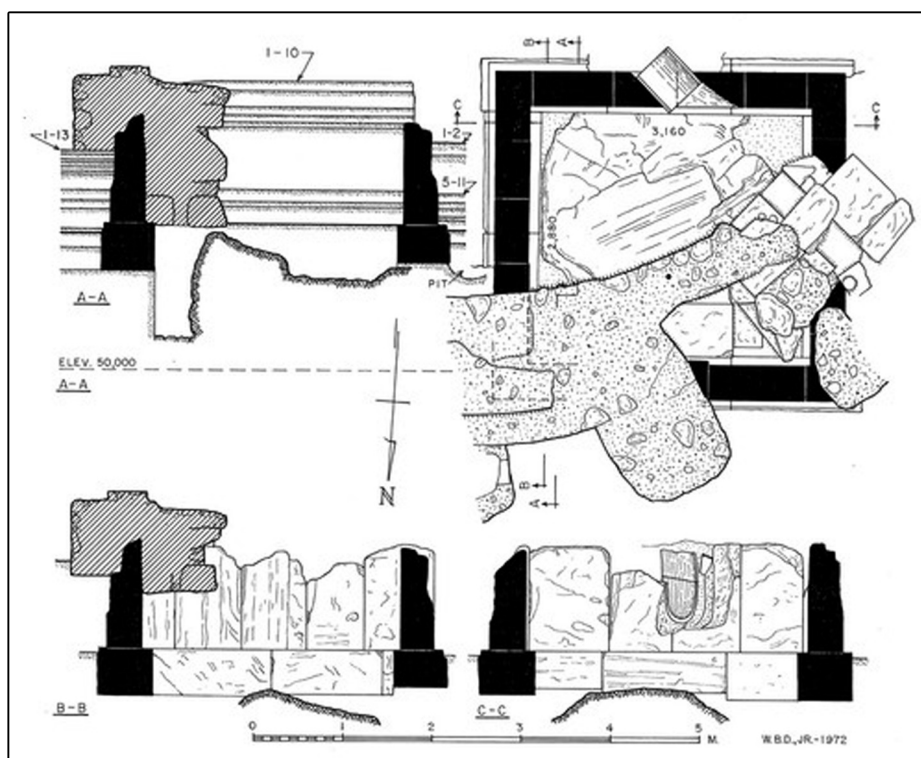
Pianta, elevato e sezione con stratigrafia interna ed esterna
